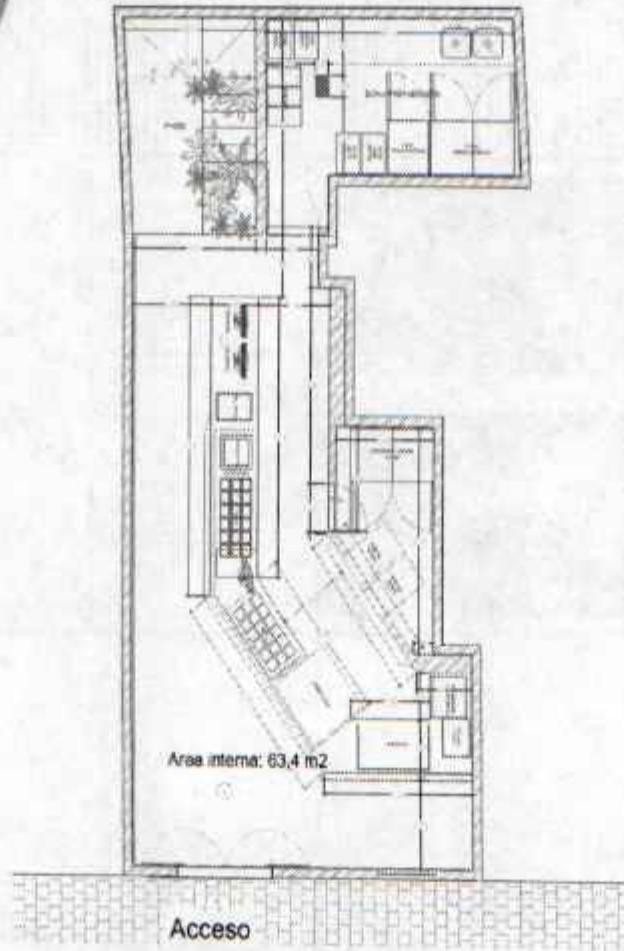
Plano PÉRCIMON CARTAGENA – Área privada
